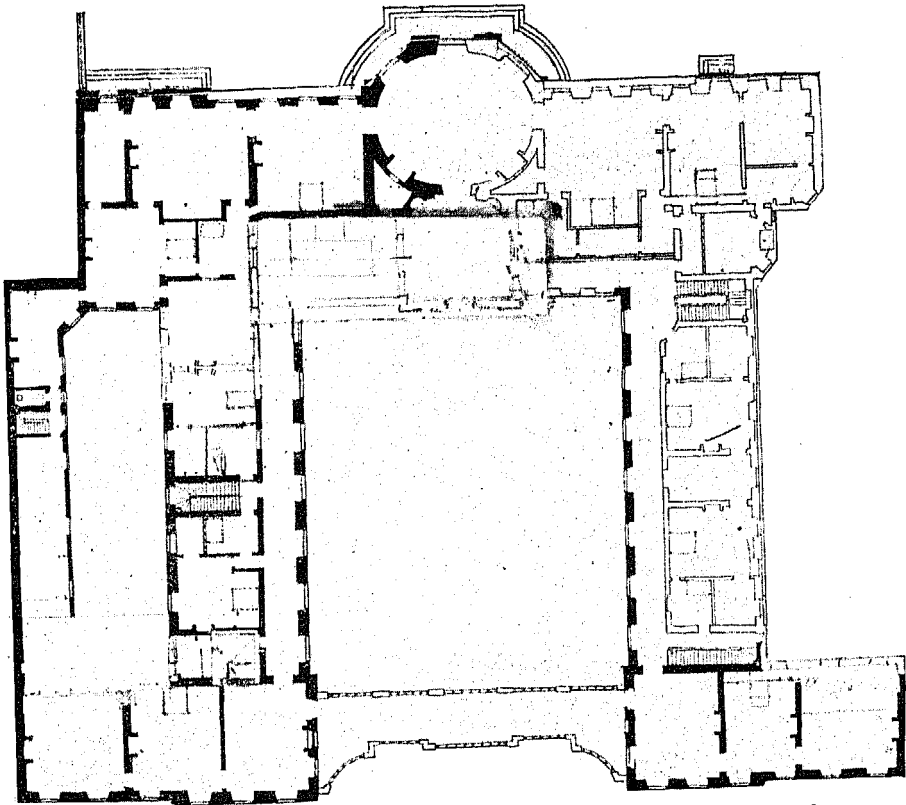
Palais Thurn und Taxis; Skizze de Cottes zum Grundriss des I. Obergeschosses.
